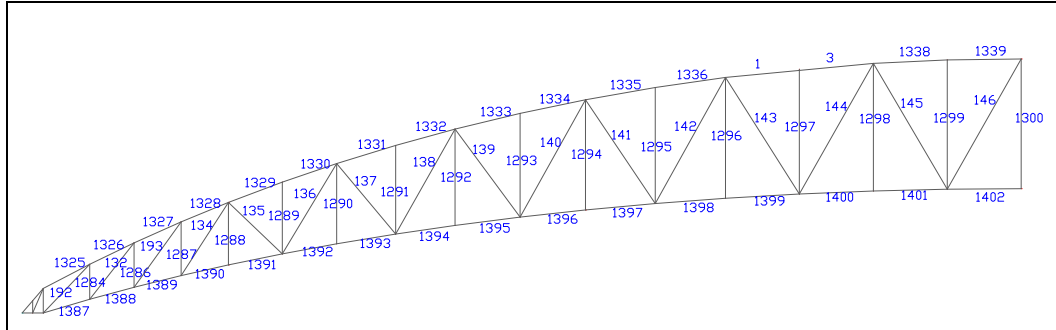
Ubicación de elementos críticos Cercha N° 6 Estructura
